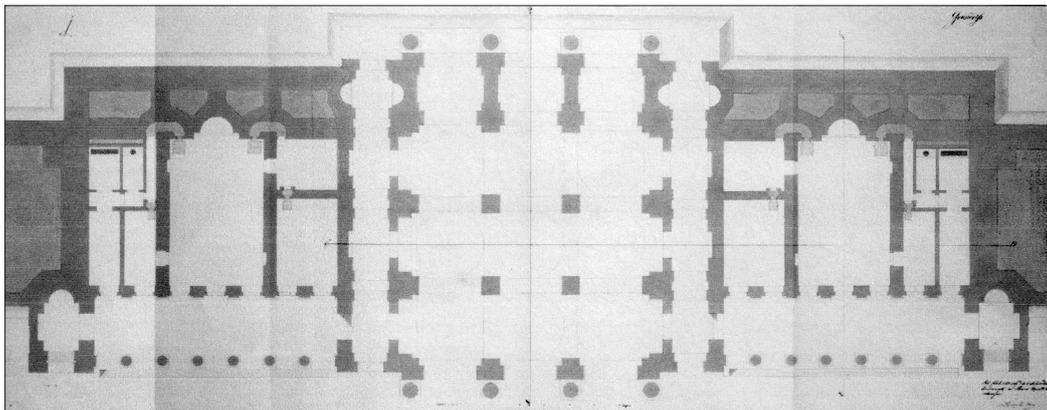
, Ludwig Remy, Äußeres Burgtor, Projekt 1820, Grundriss, Albertina Wien
